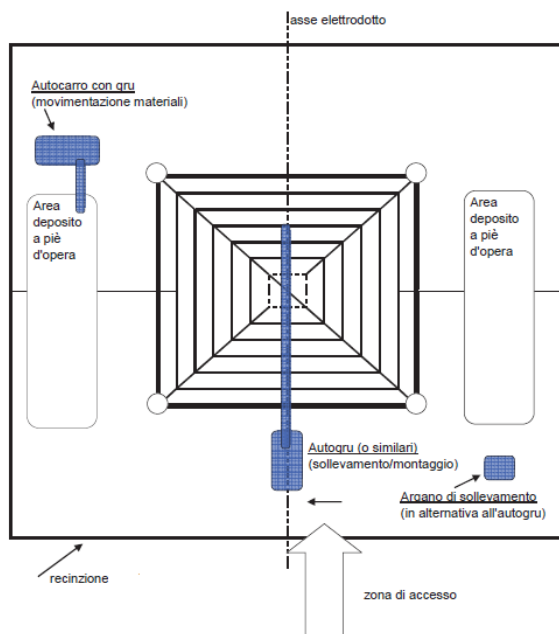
Planimetria tipologica del microcantiere nella fase di montaggio del sostegno
